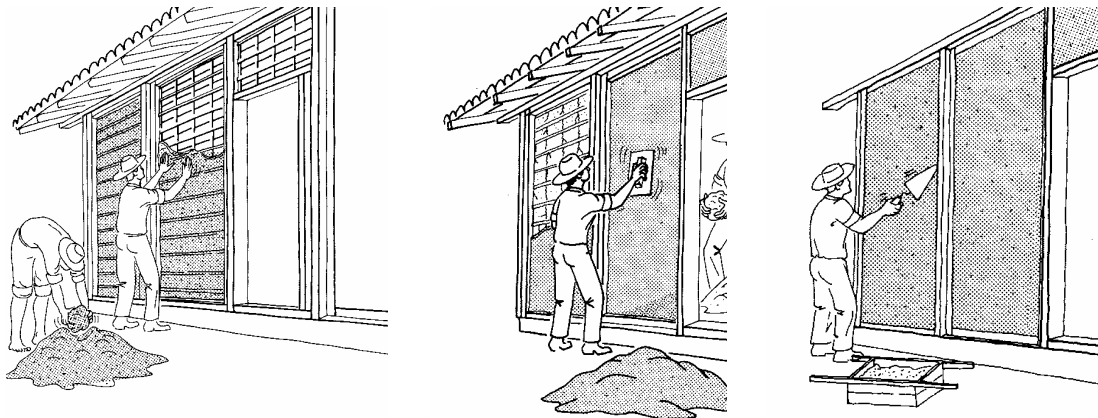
Processo de enchimento da trama, em construção de taipa de mão, com aplicação das três camadas de terra crua. Fonte: FUNDAÇÃO DAM (1988).
